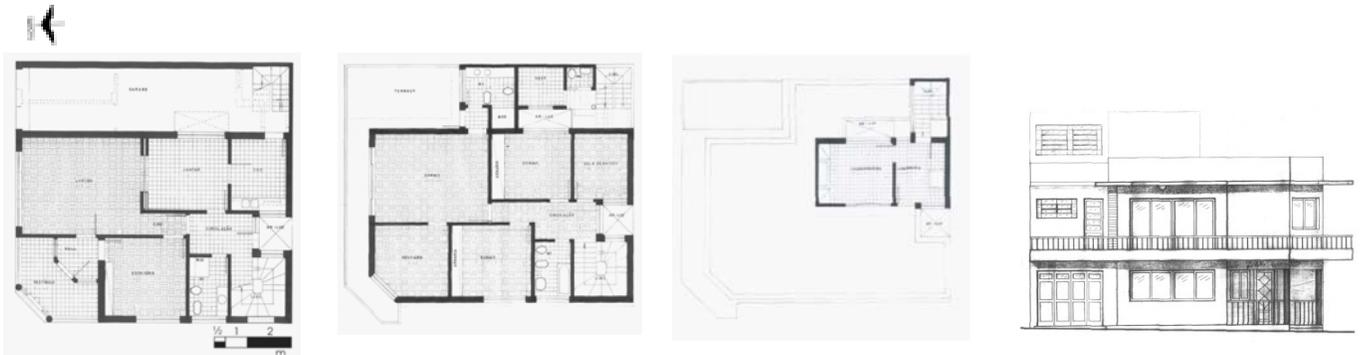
Casa Edson Brasil. Plantas baixas pavimento térreo, superior, terraço e Fachada.
